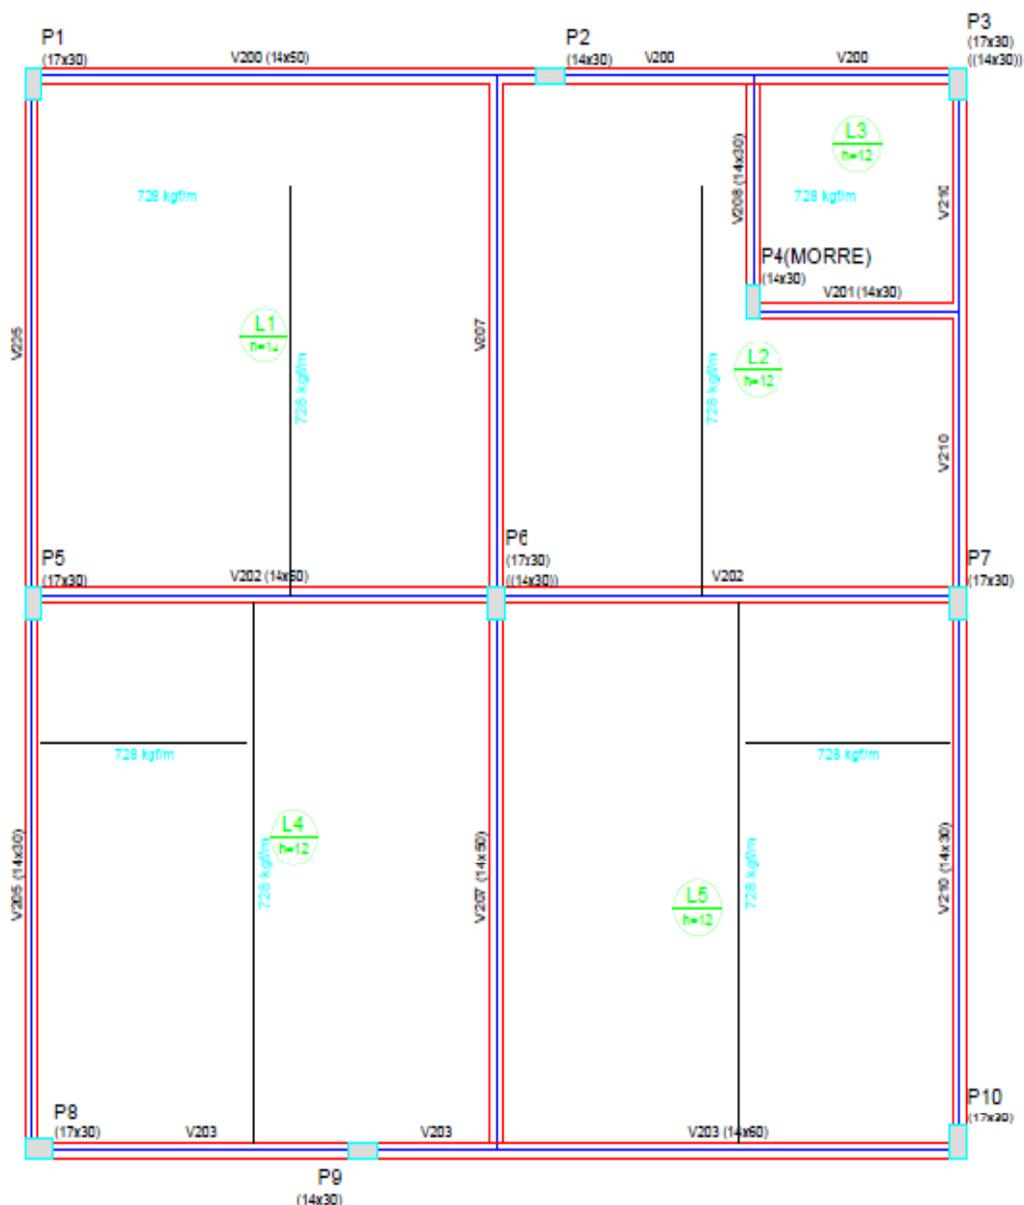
PLANTA DE FORMAS DO PAVIMENTO 2 DA ETAPA 2
